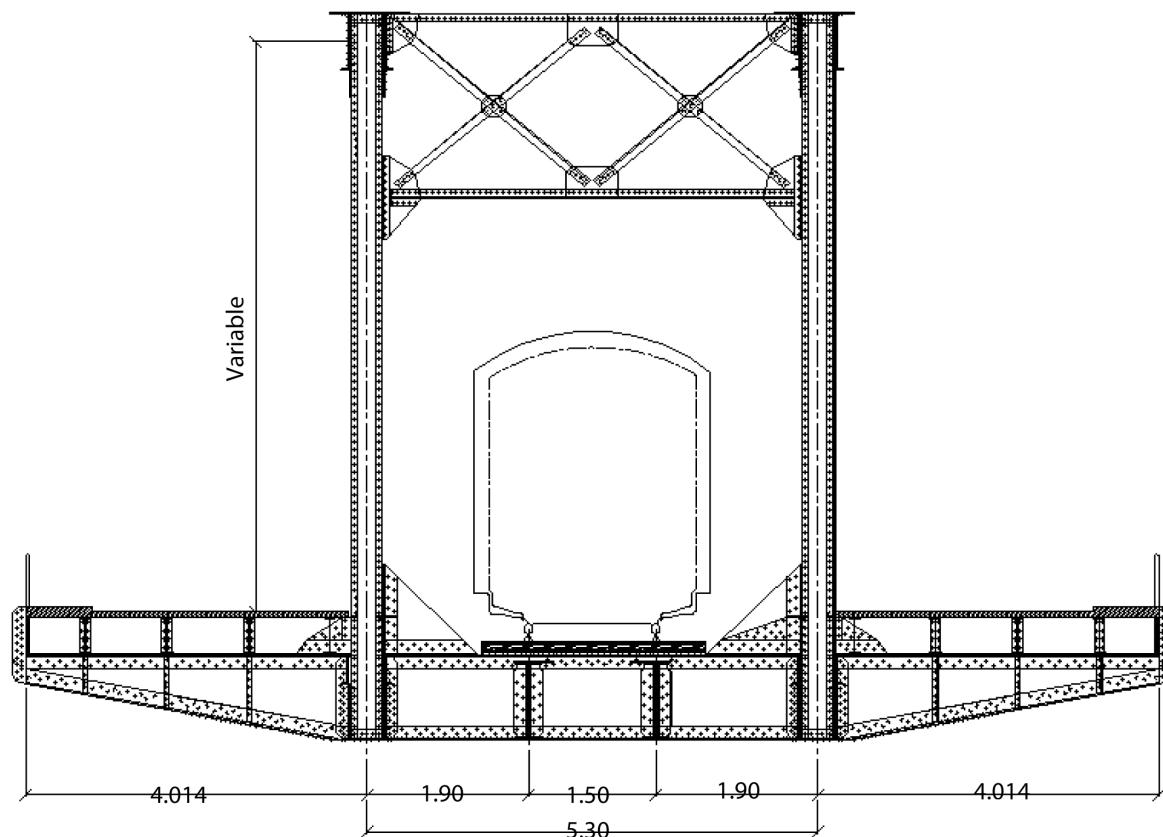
b : Coupe transversale du pont-rails d'Edfina.
